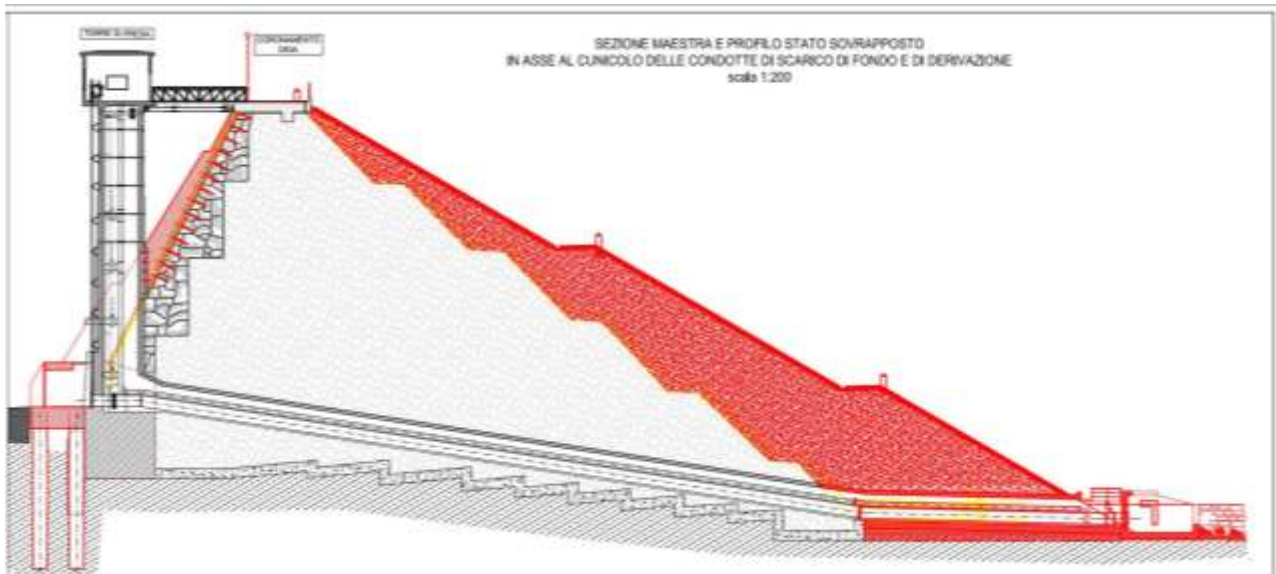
Sezione maestra dell'opera di sbarramento. Stato sovrapposto. In rosso gli interventi in progetto (elaborato T-P02\_s)
